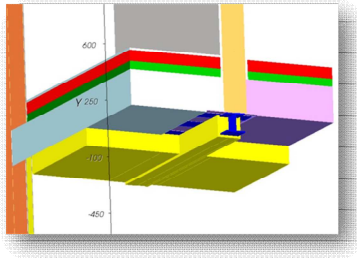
Detail - Auflagerbereich Stahlträger zur Unterfangung einer Trennwand, links Anschluss Dippelbaumdecke, rechts Anschluss Stahlbetondecke, abgehängte Decke nicht dargestellt (o.M.)
